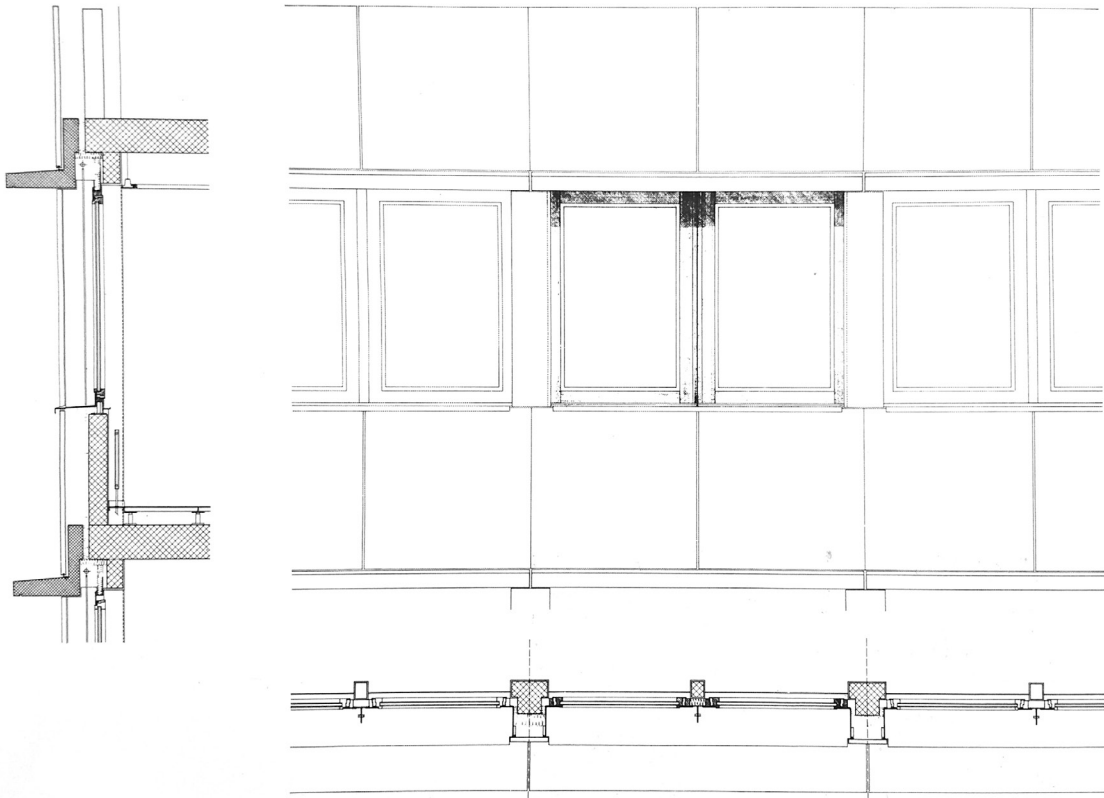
Corte, alçado e planta construtiva do módulo da fachada
